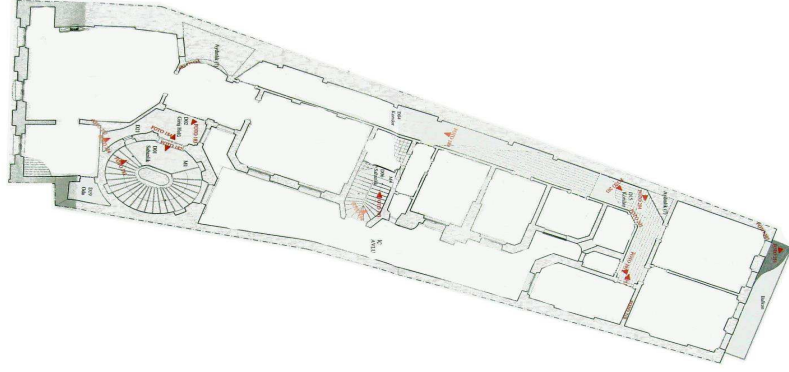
Botter Apartmanı Birinci Kat Planı
